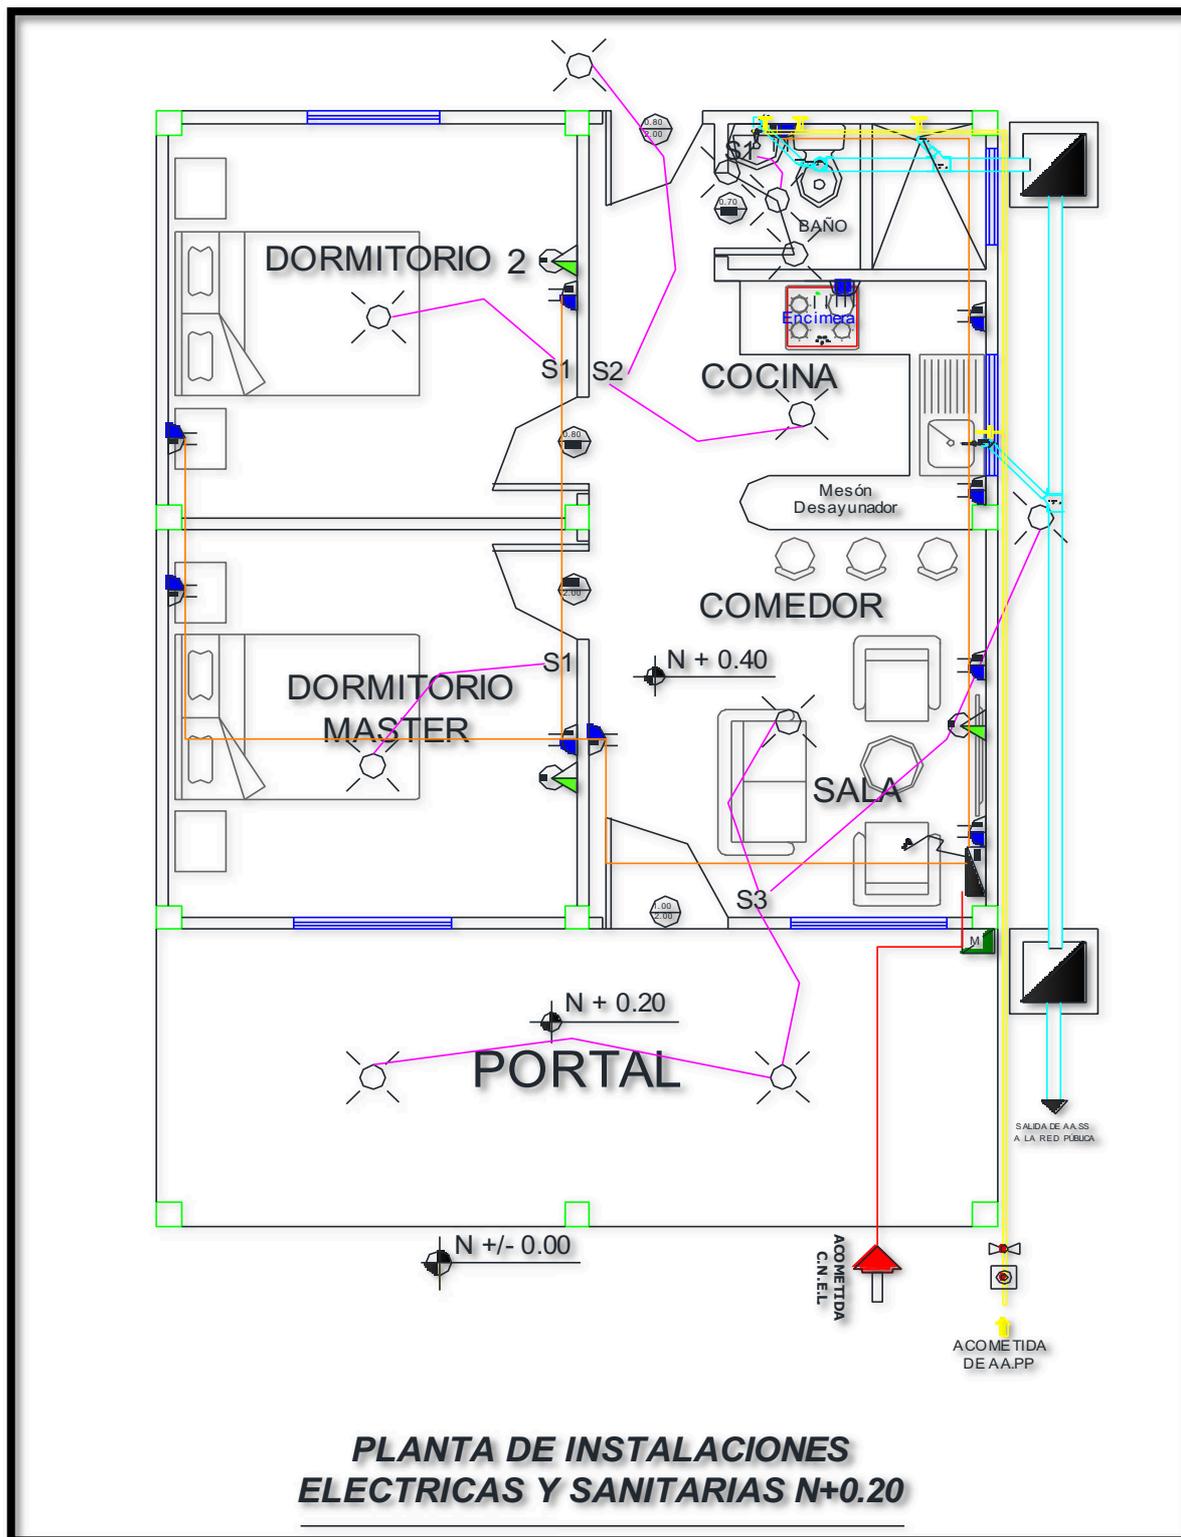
Planta de Instalaciones Eléctricas y Sanitarias
